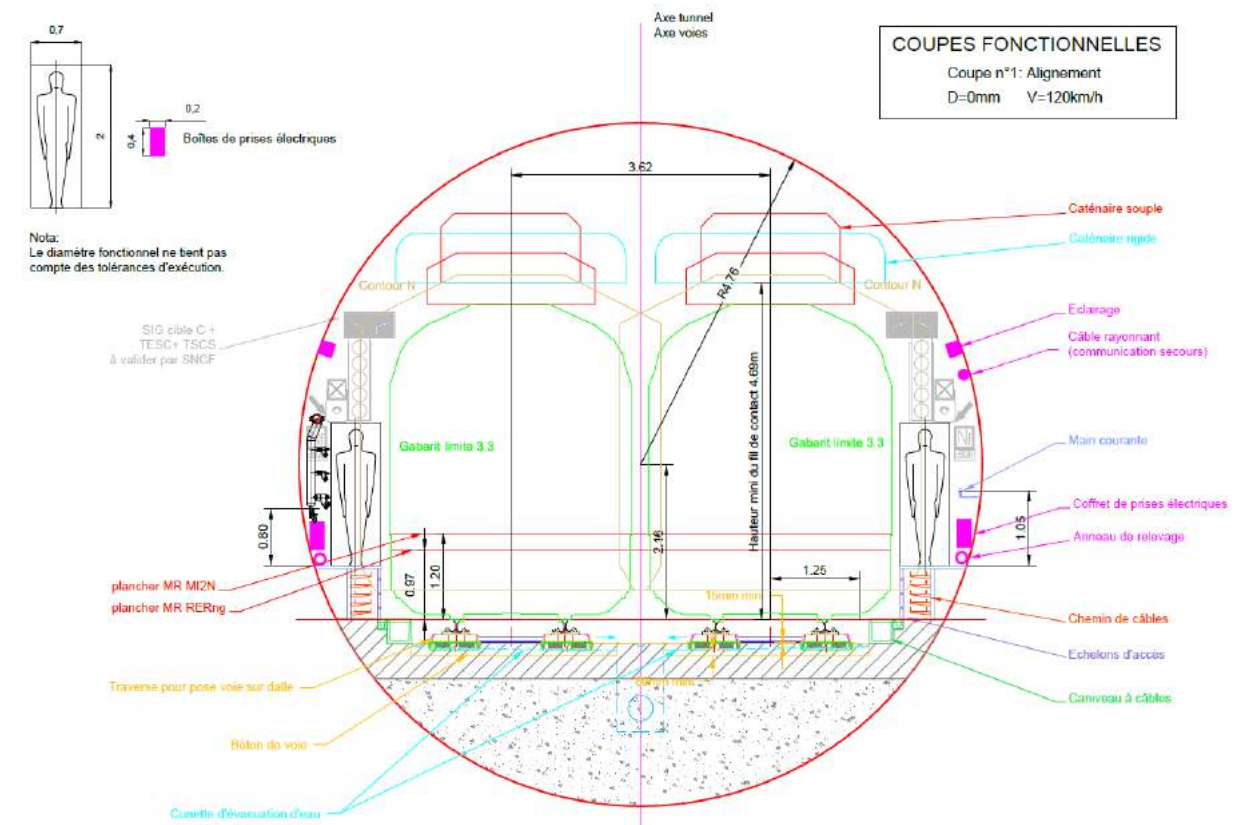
Coupe type du tunnel – Monotube foré au tunnelier
